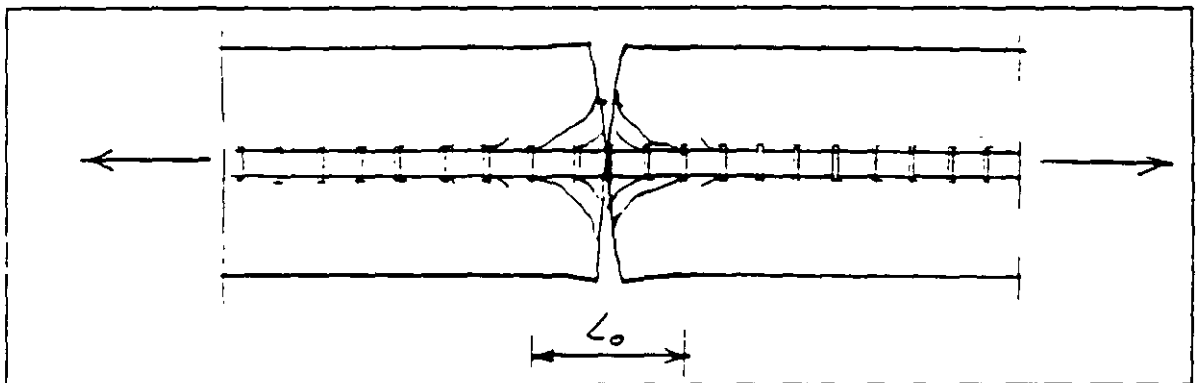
Distancia de deslizamiento,  $l_0$ , en la grieta
